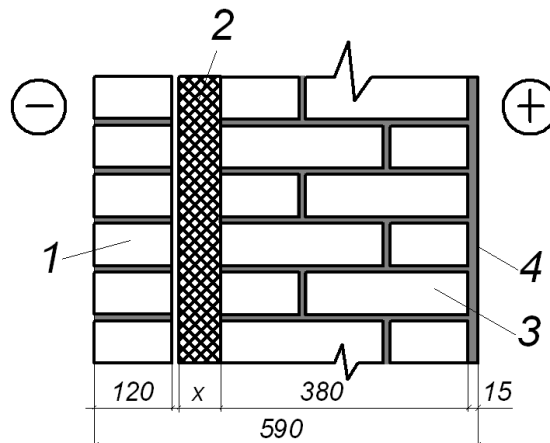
розрахункова схема утеплення зовнішньої стіни будівлі:
